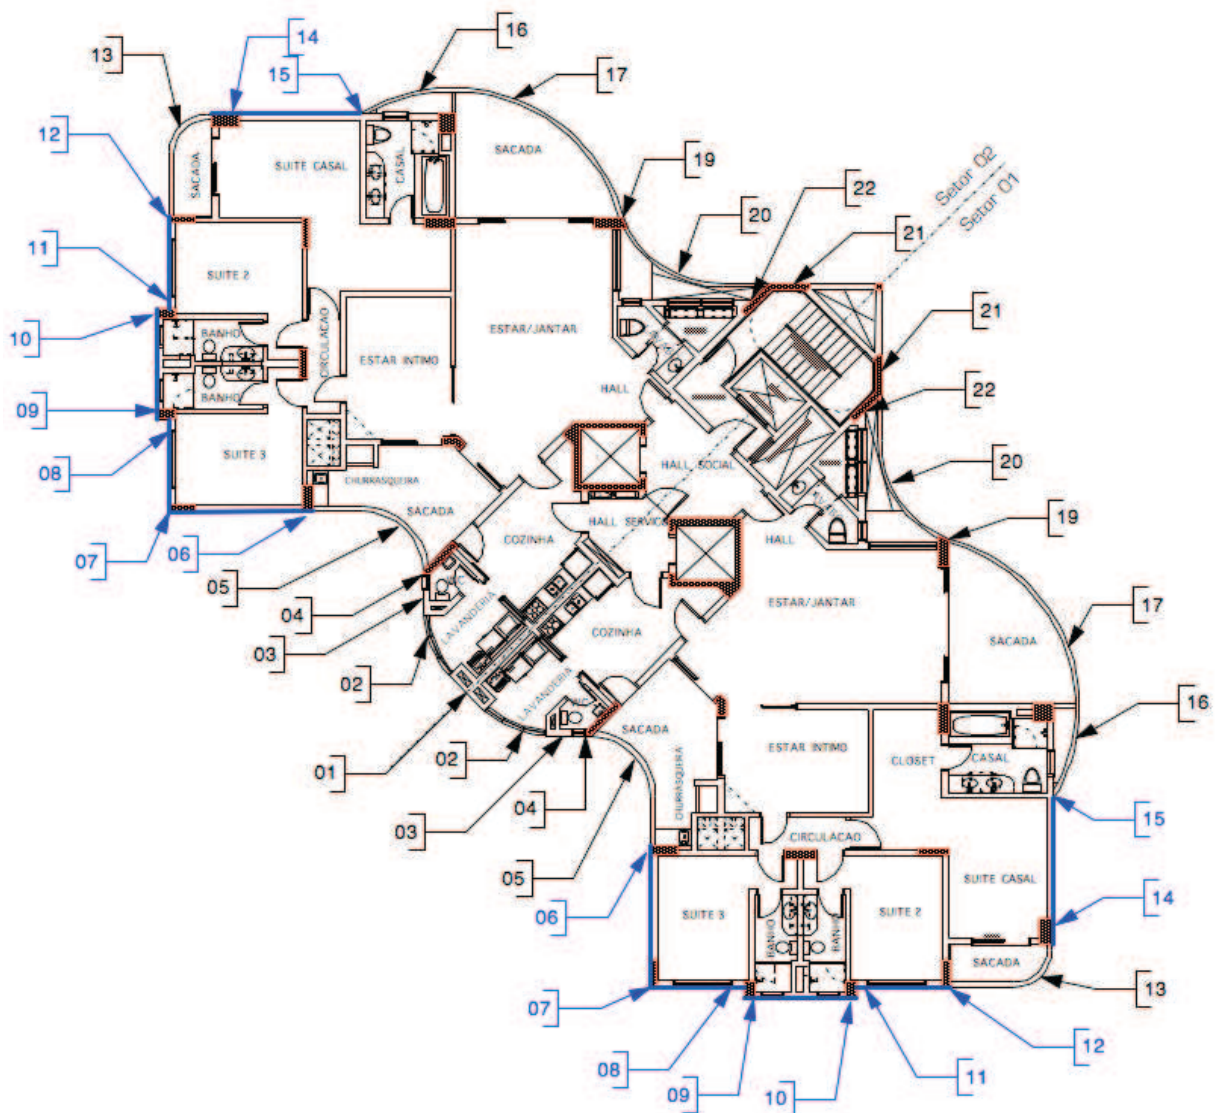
Planta Baixa – pontos de controle de prumo – sem escala
